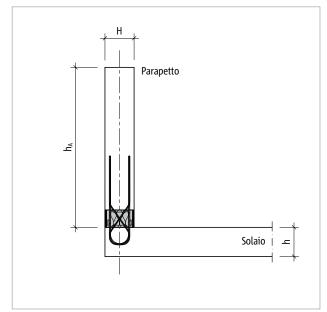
Schöck Isokorb® XT tipo AP: schema statico con altezza del parapetto $h_{\rm A}$
